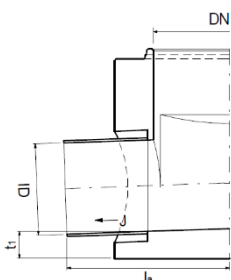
Anschluss mit eingebautem Schachtfutter in Schachtwand
